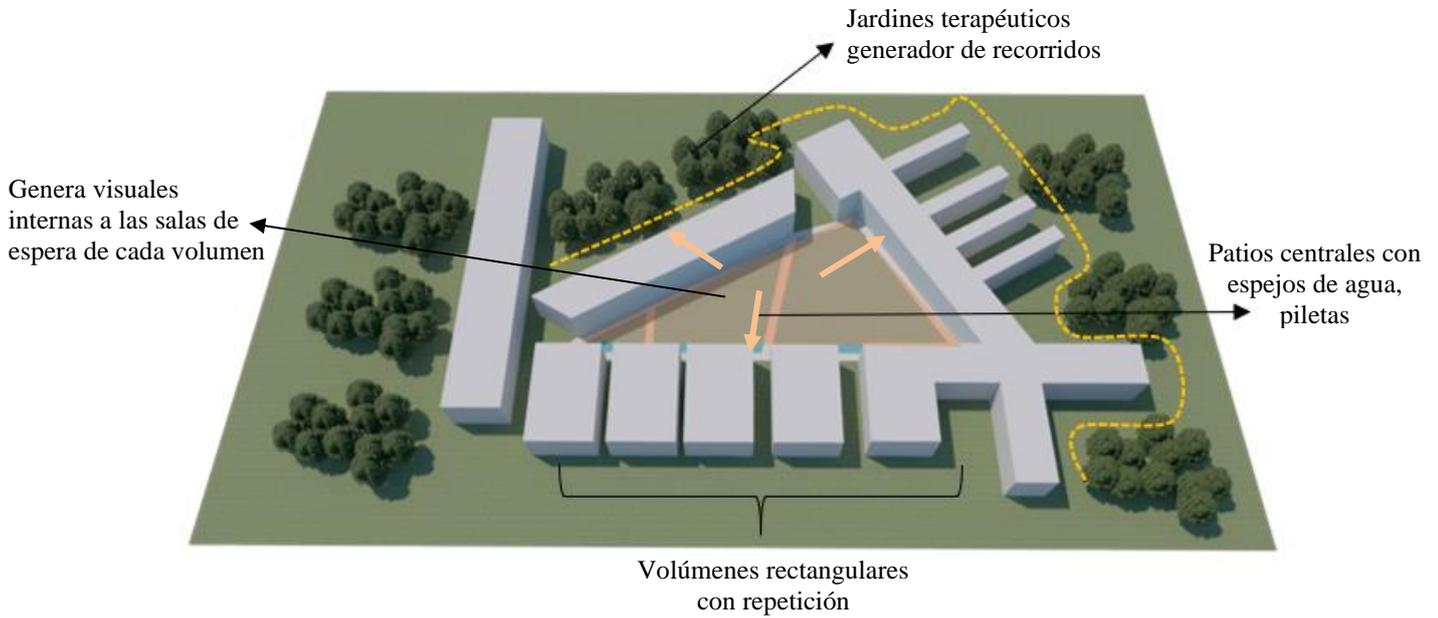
Boceto de fachada de caso 5. Fuente: Elaboración propia
